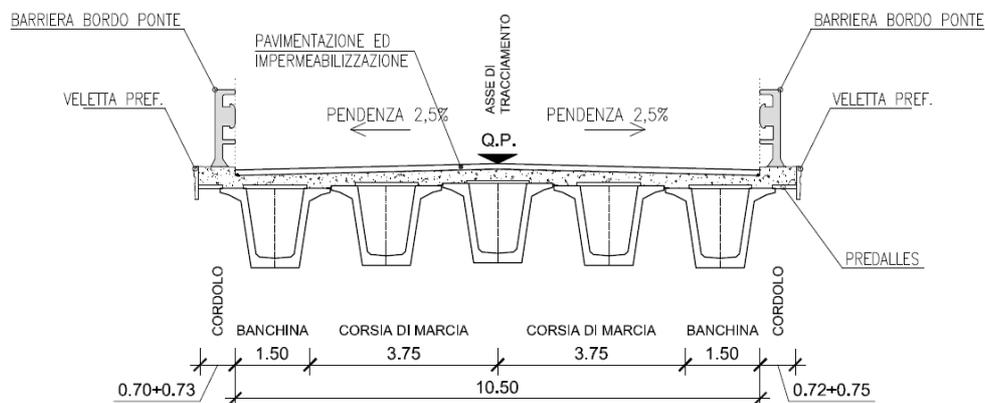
SEZIONE TIPO SU VIADOTTO
